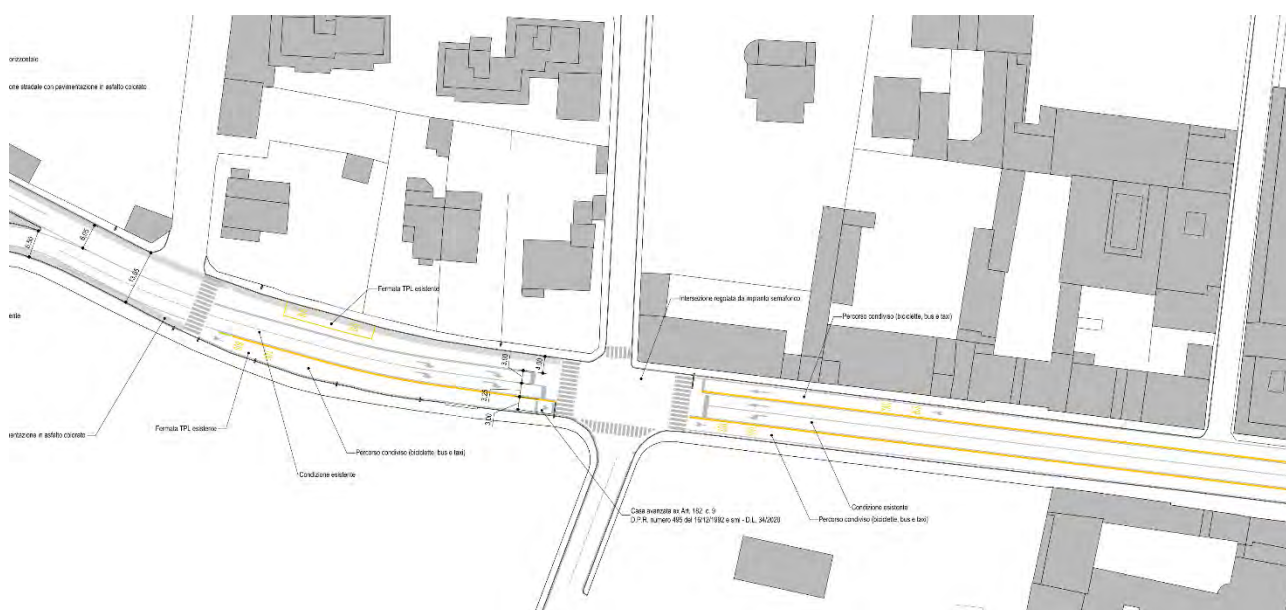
L'assetto del tratto via Sacco – via Sanvito
